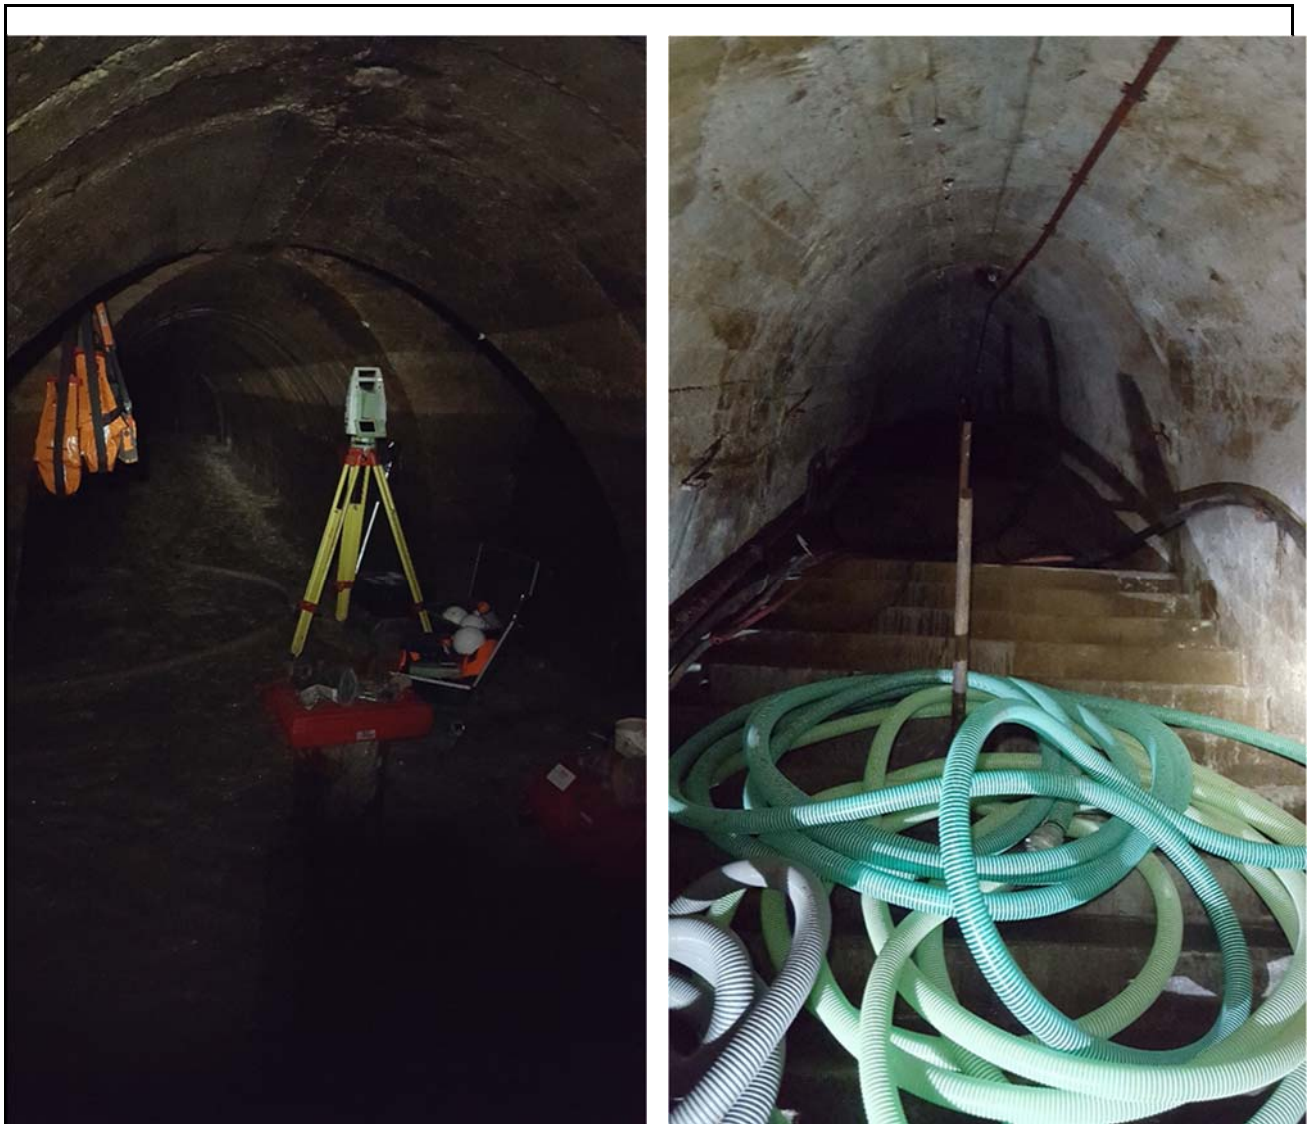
und 7: links: Aufbau der Gerätschaften, rechts: Einbau Belüftung
